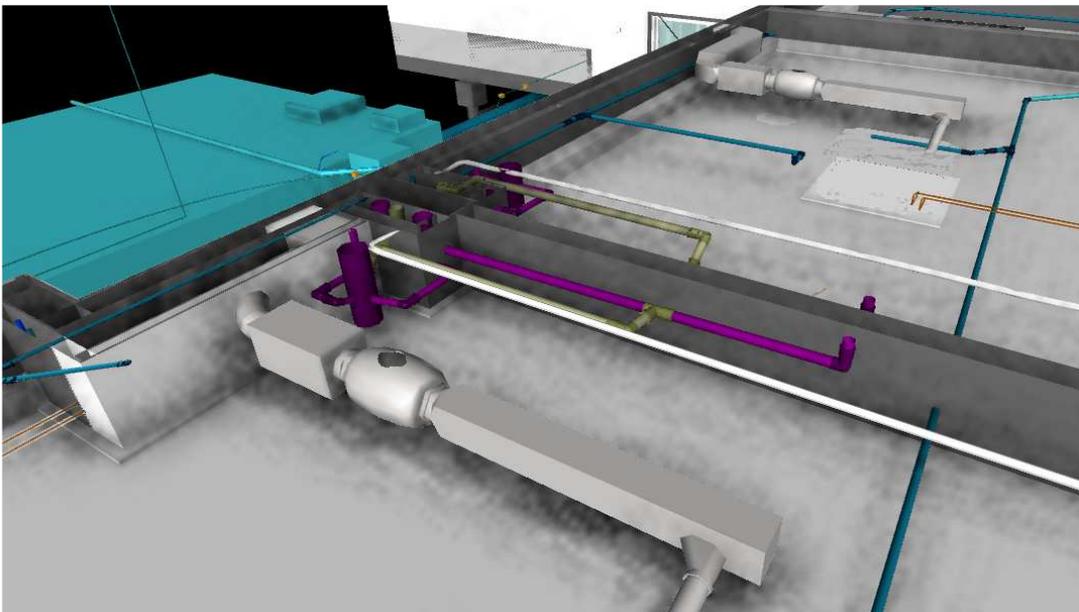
Conflito de instalações hidráulicas e de renovação de ar na brinquedoteca
